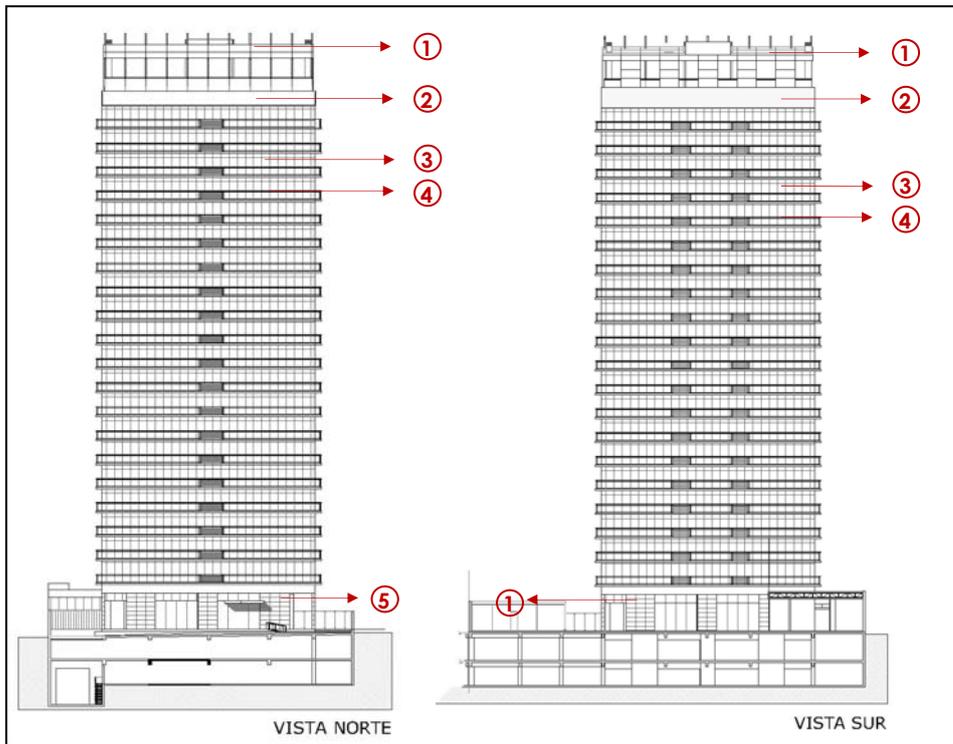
Fachadas Norte y Sur del edificio Da Vinci
